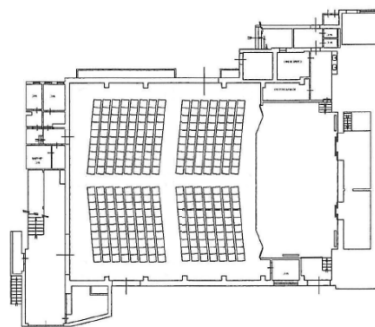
Planimetria del teatro E. De Filippo di Cecina
